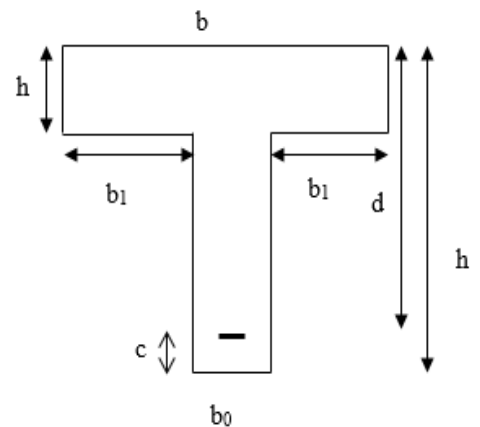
Section de calcul de la poutrelle après coulage de la dalle de compression (Section en T)
